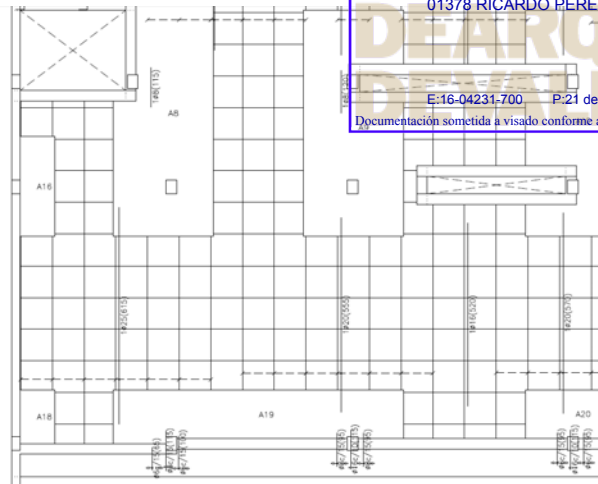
Armadura longitudinal inferior necesaria previamente a la intervención
